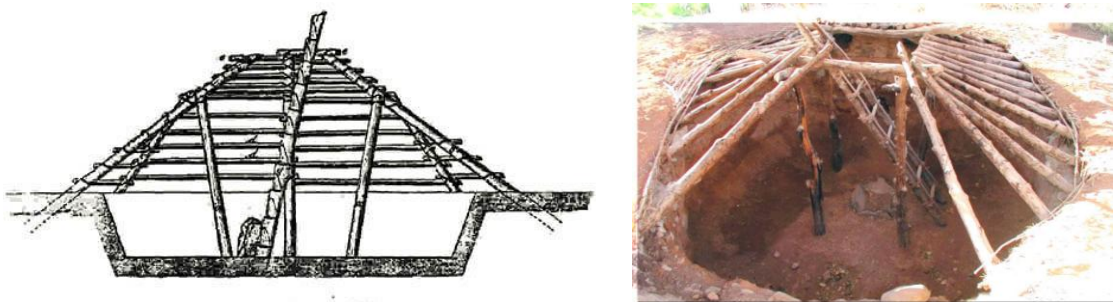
Construções subterrâneas ou “pit-house” [11] [12]
